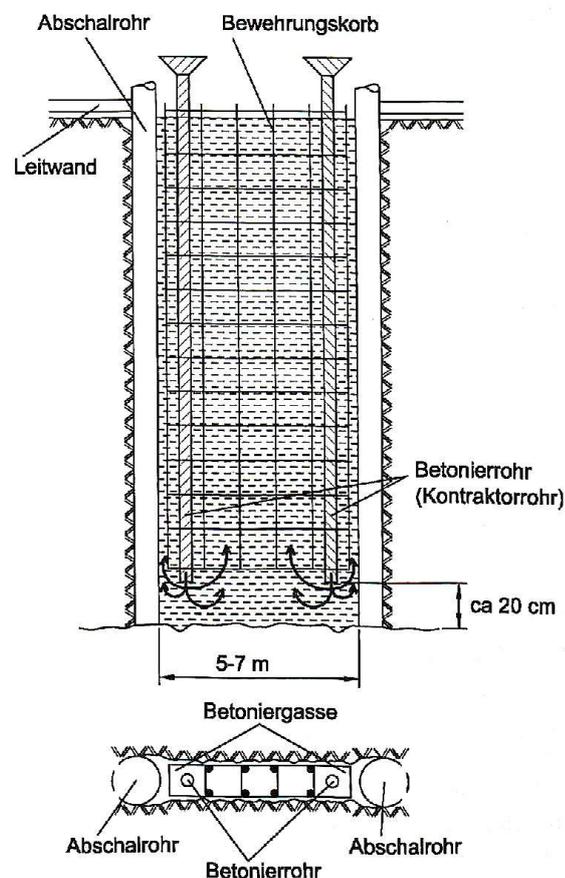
Betonierrohre (Schüttrohre) in Betoniergassen [17]
